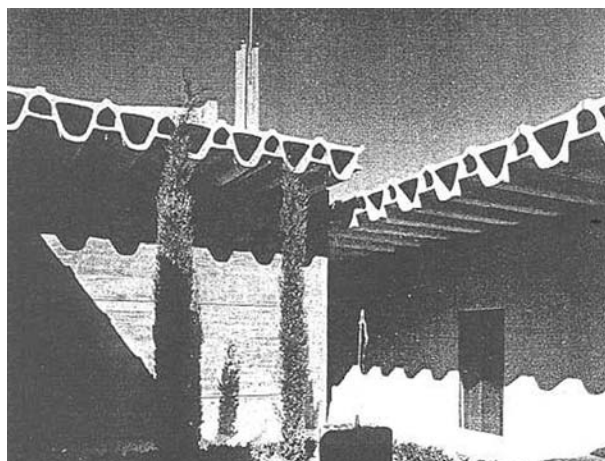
Aplicación de piezas huecas a cubiertas y forjados.
